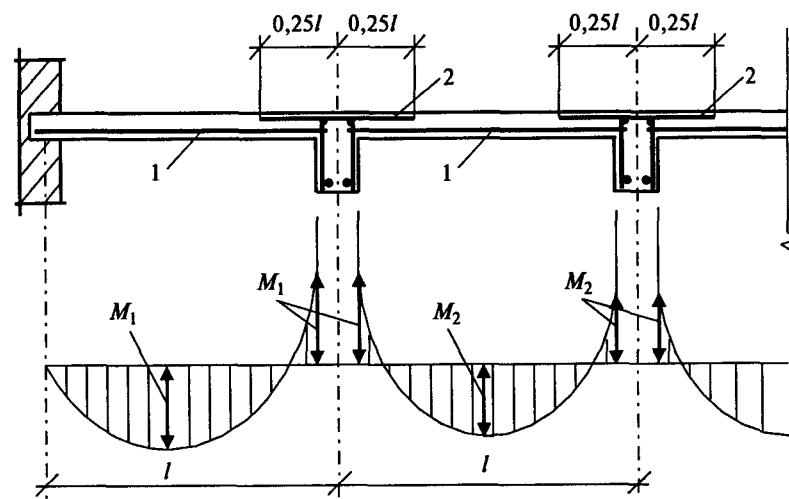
Эпюра моментов и армирование плиты ребристого перекрытия:
